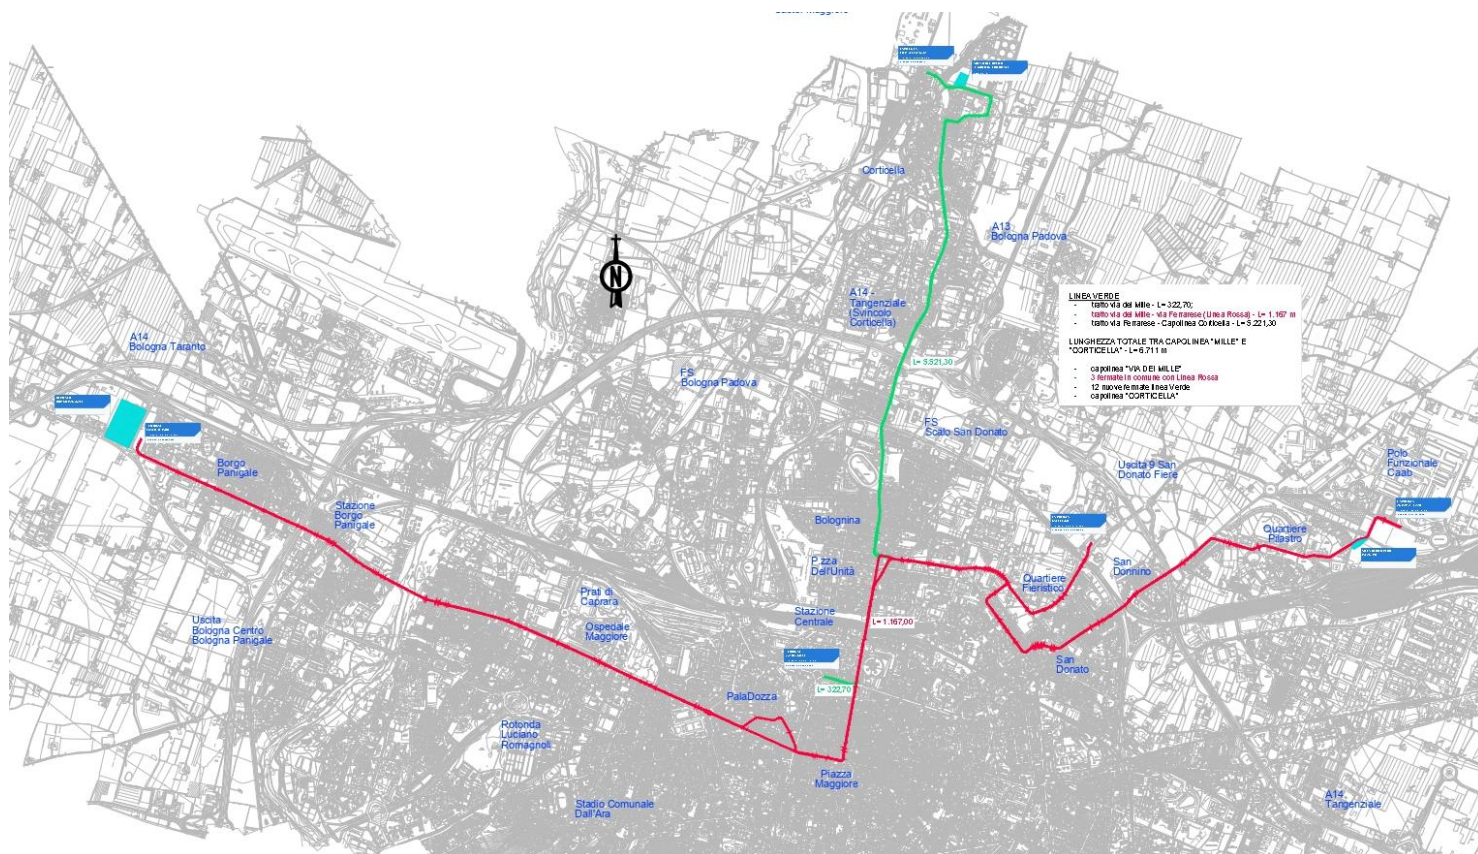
Planimetria generale Linea Rossa + Tratta nord Linea Verde
